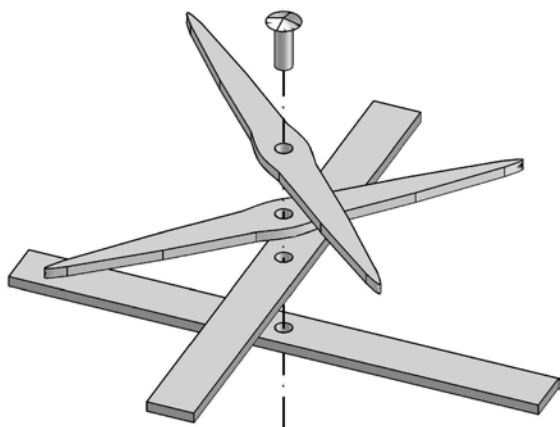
Konstruktionsschema Fenstergitter Typ IIB1.
